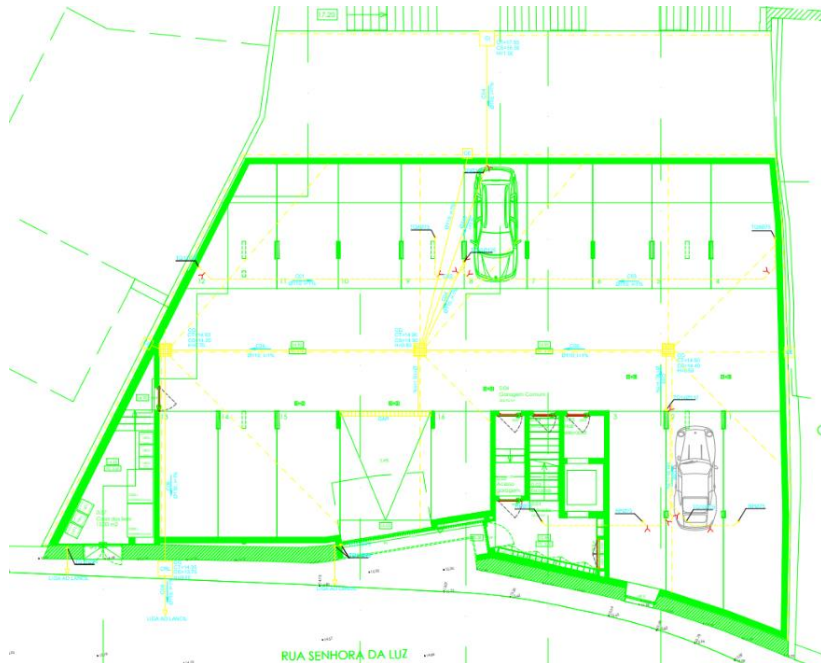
Subprojeto águas pluviais edifício novo piso -1/0.
